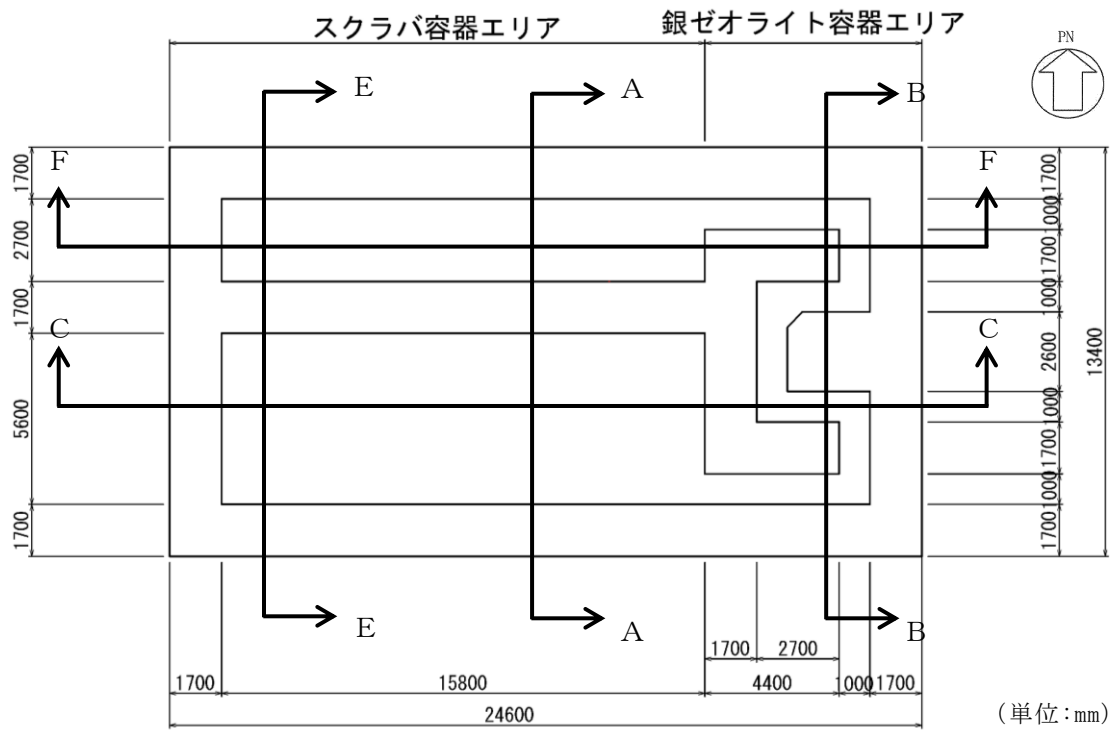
(1) 第 1 ベントフィルタ格納槽 平面図 (EL 3.00m)
